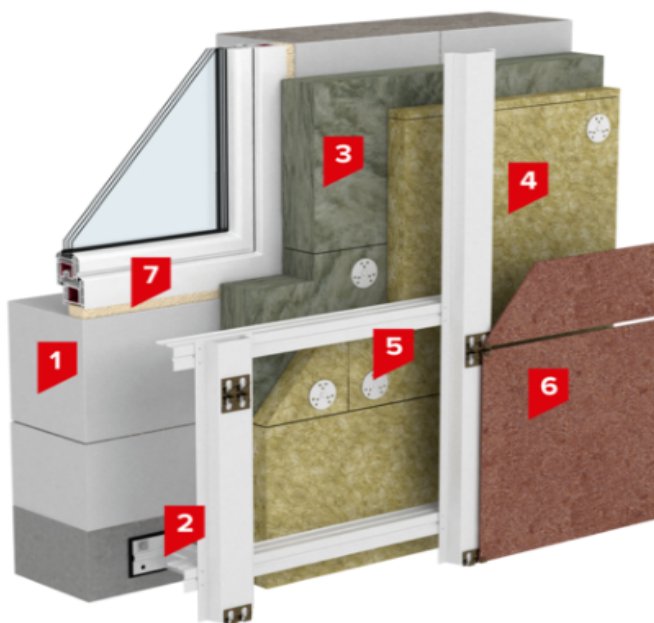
Типовой узел «Вентилируемого фасада» «ТН Фасад Вент» системы «ТЕХНОНИКОЛЬ»
